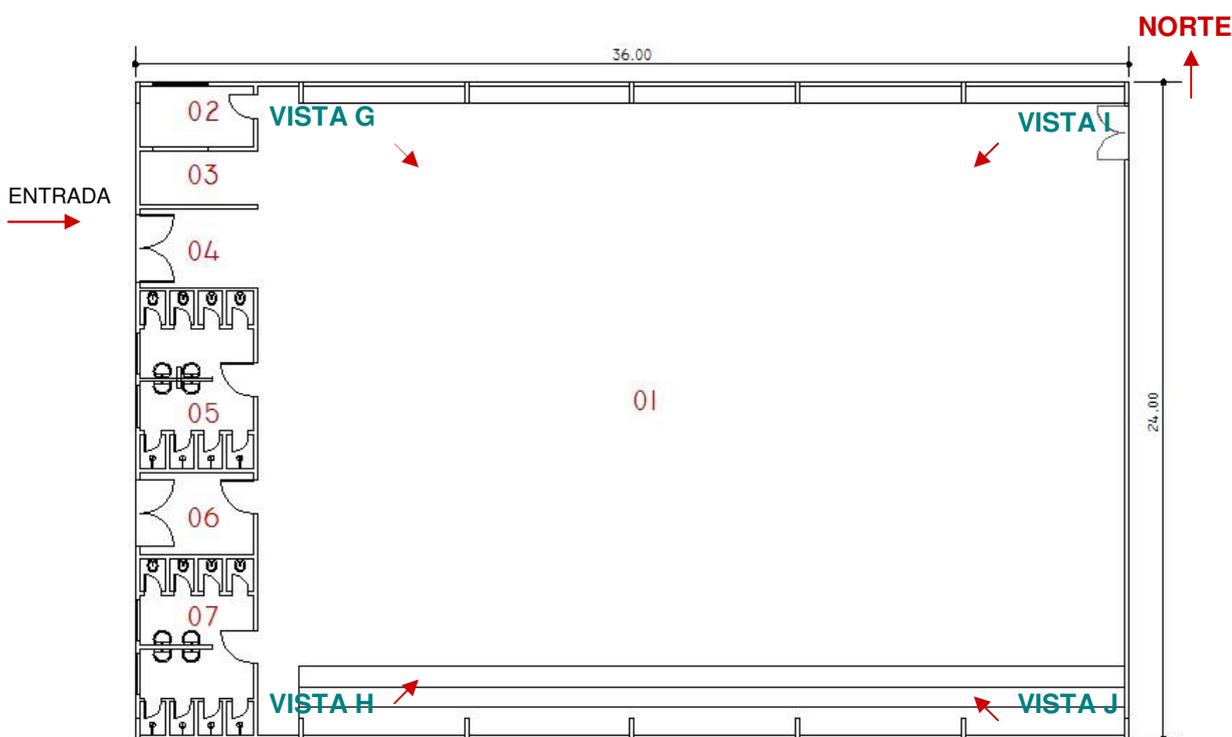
Planta do Ginásio de Esportes da Escola Estadual, indicação vista externas.
